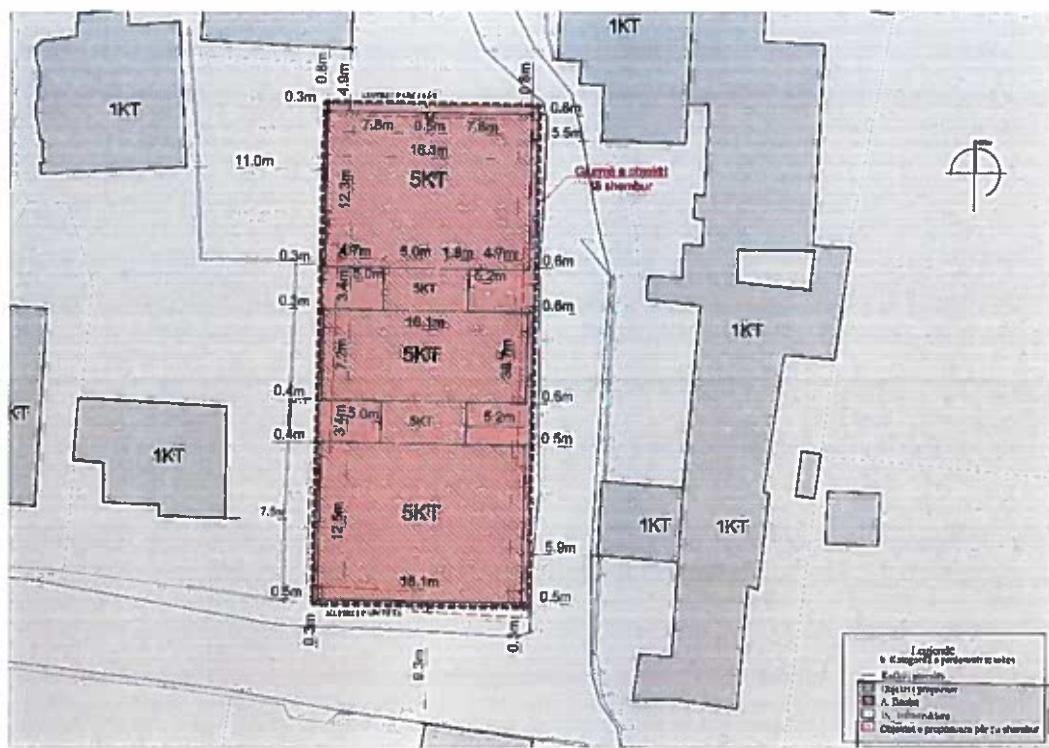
Plani i përdorimit të tokës të banesave nr. 19, Rajoni nr. 4, Bashkia Durrës.
